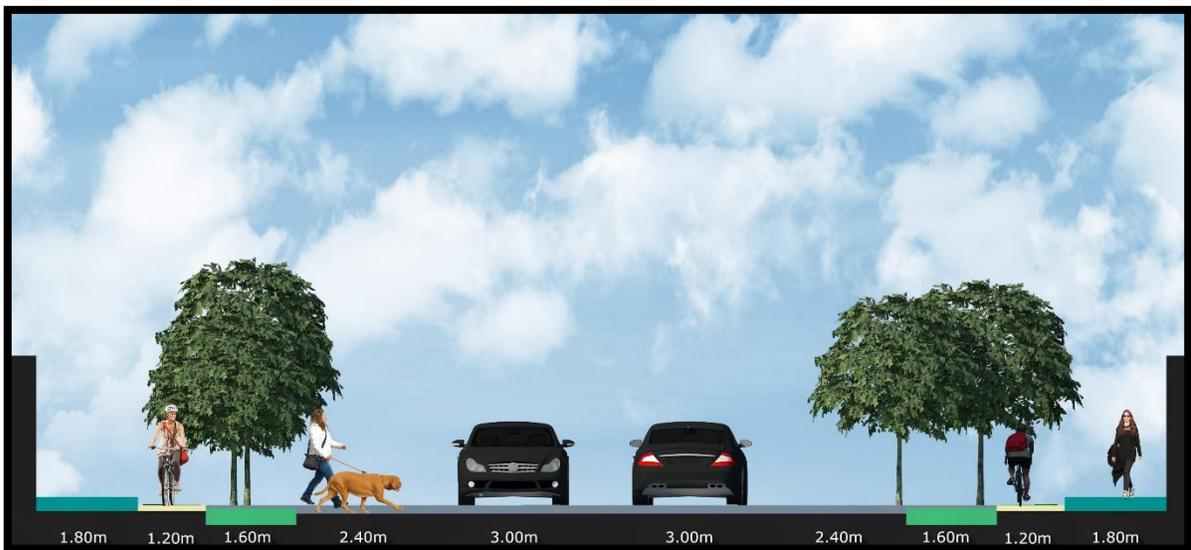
Alzado prototipo 2. Diseño de vialidad que incluye la sección de la calle Emiliano Zapata. Fuente: Elaboración propia
